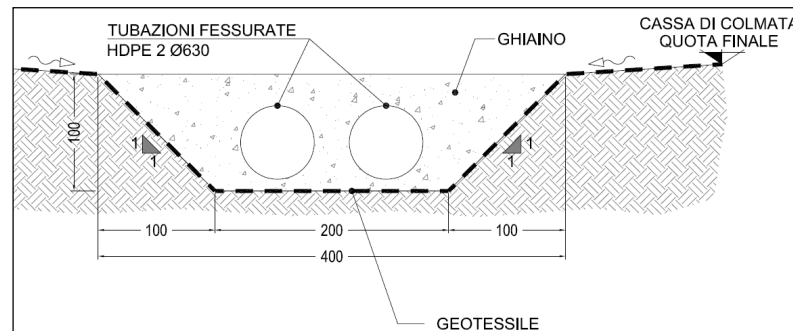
Area 10 - Sezione tipologica trincea drenante
